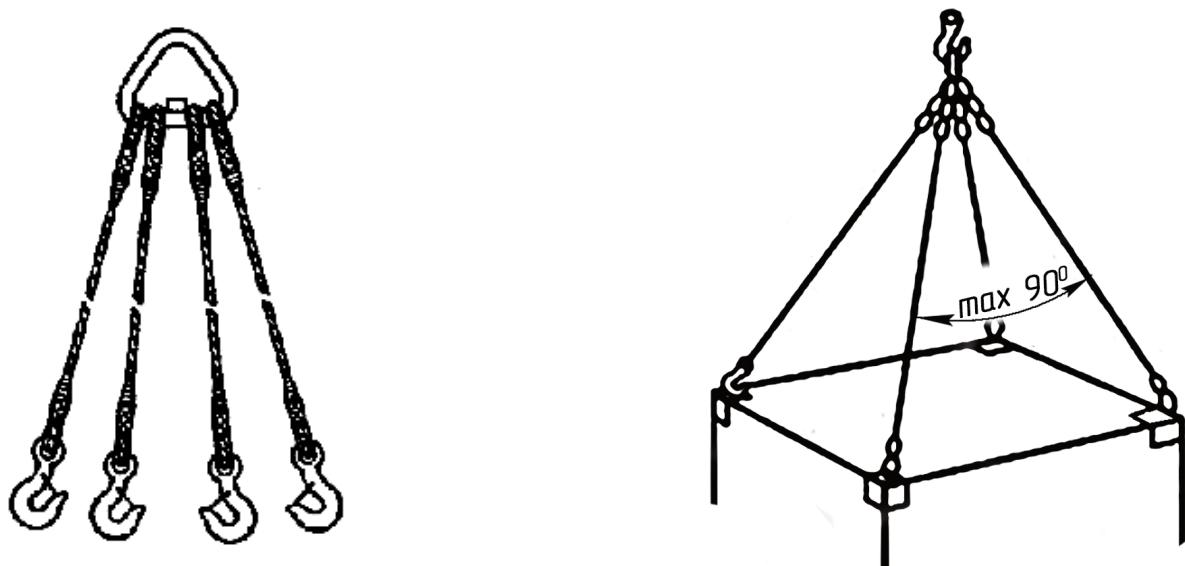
Внешний вид строповочного приспособления, максимально допустимый угол между ветвями приспособлениями
